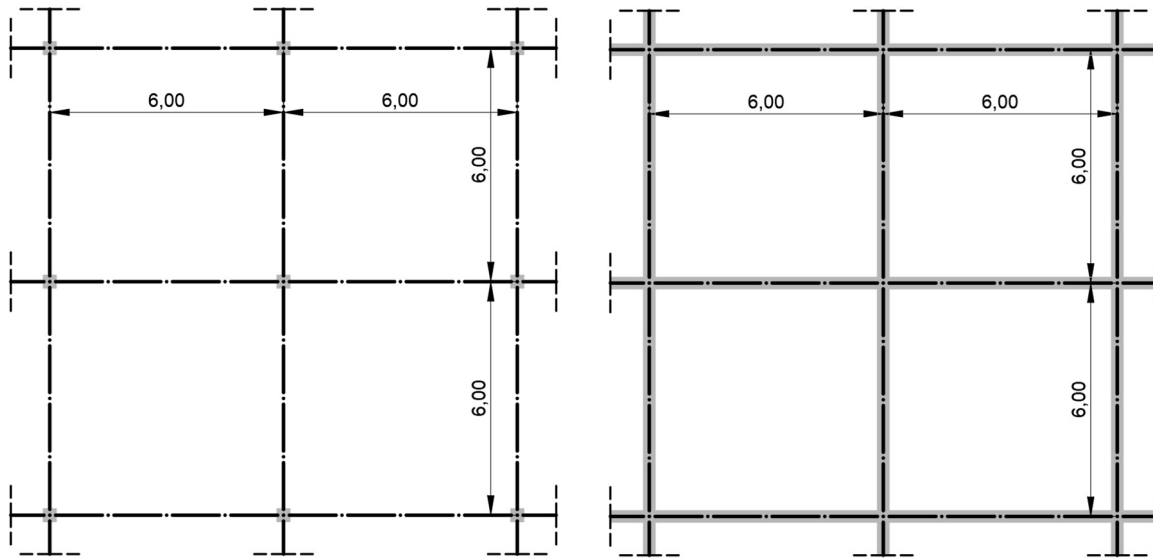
Grundrisse der untersuchten Decken. Links: Lagerung durch Stützen, rechts: Lagerung durch Wände
